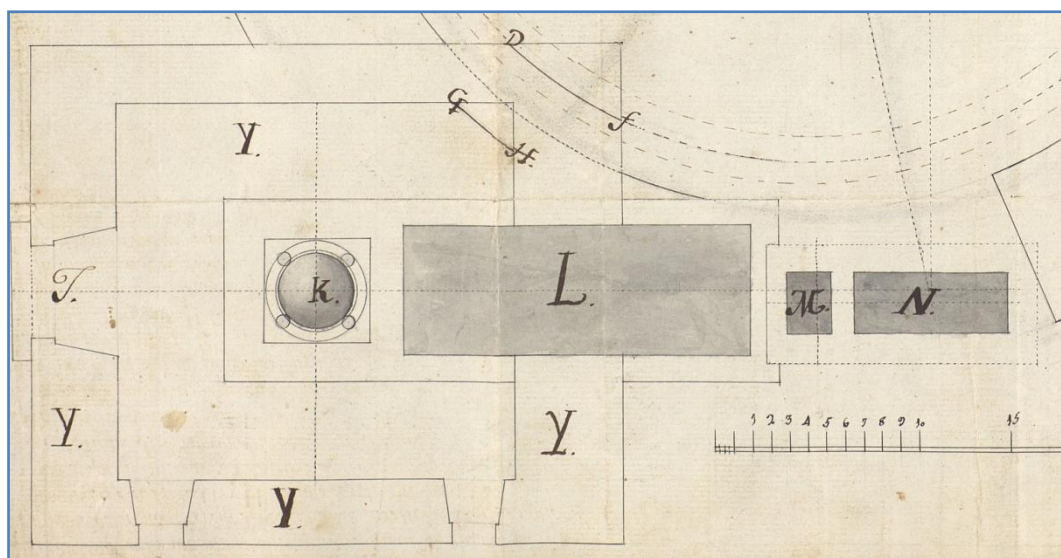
Detalle de la planta del edificio de la máquina de vapor. Plano FCMA-1488.
